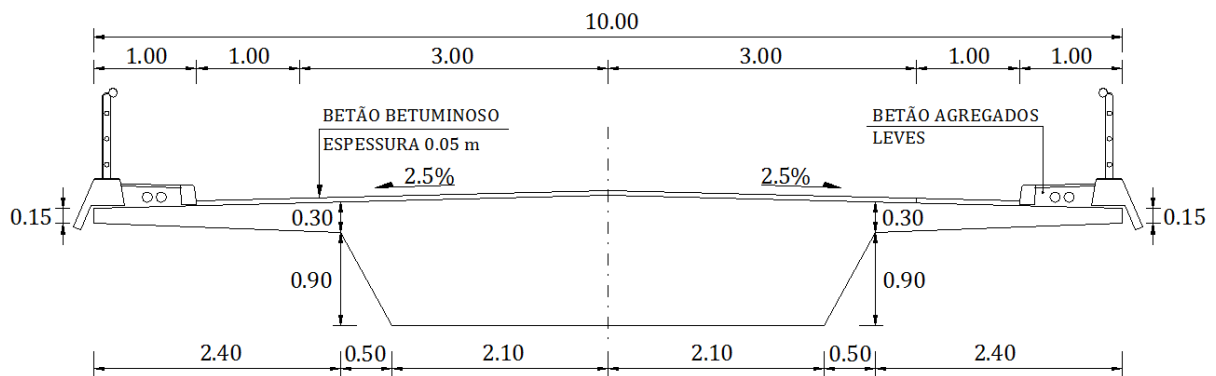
Secção transversal do tabuleiro (caso de estudo 2)
